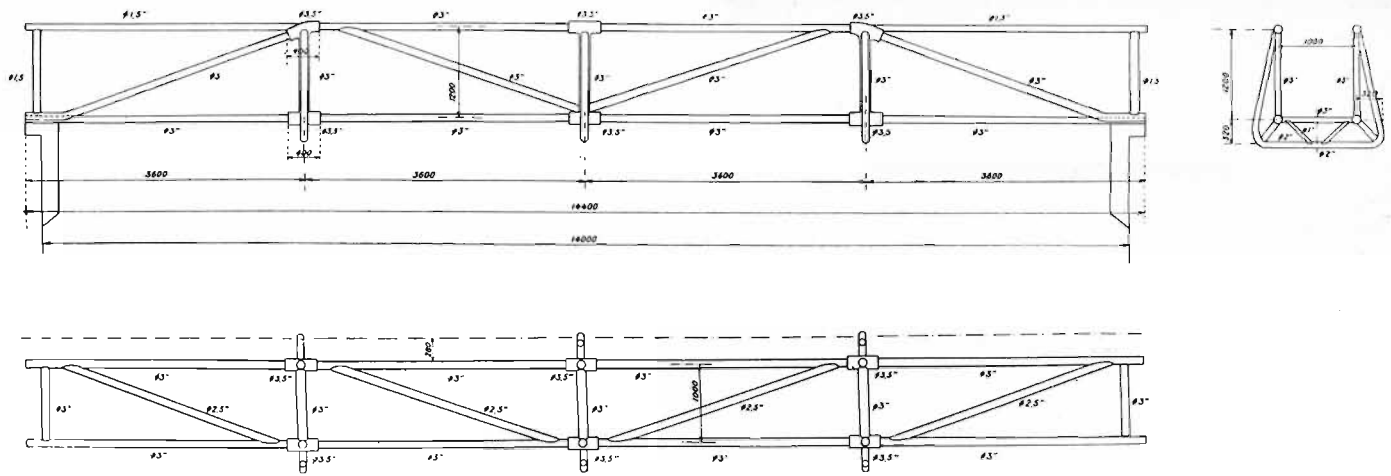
Elévation, plan et section de la passerelle de Wiesberg (Autriche).
